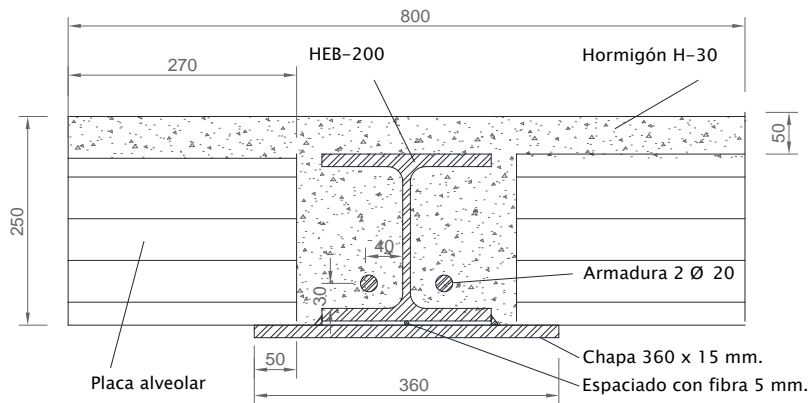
Sección de la viga A7. Tipo SFB. (Cotas en mm)
